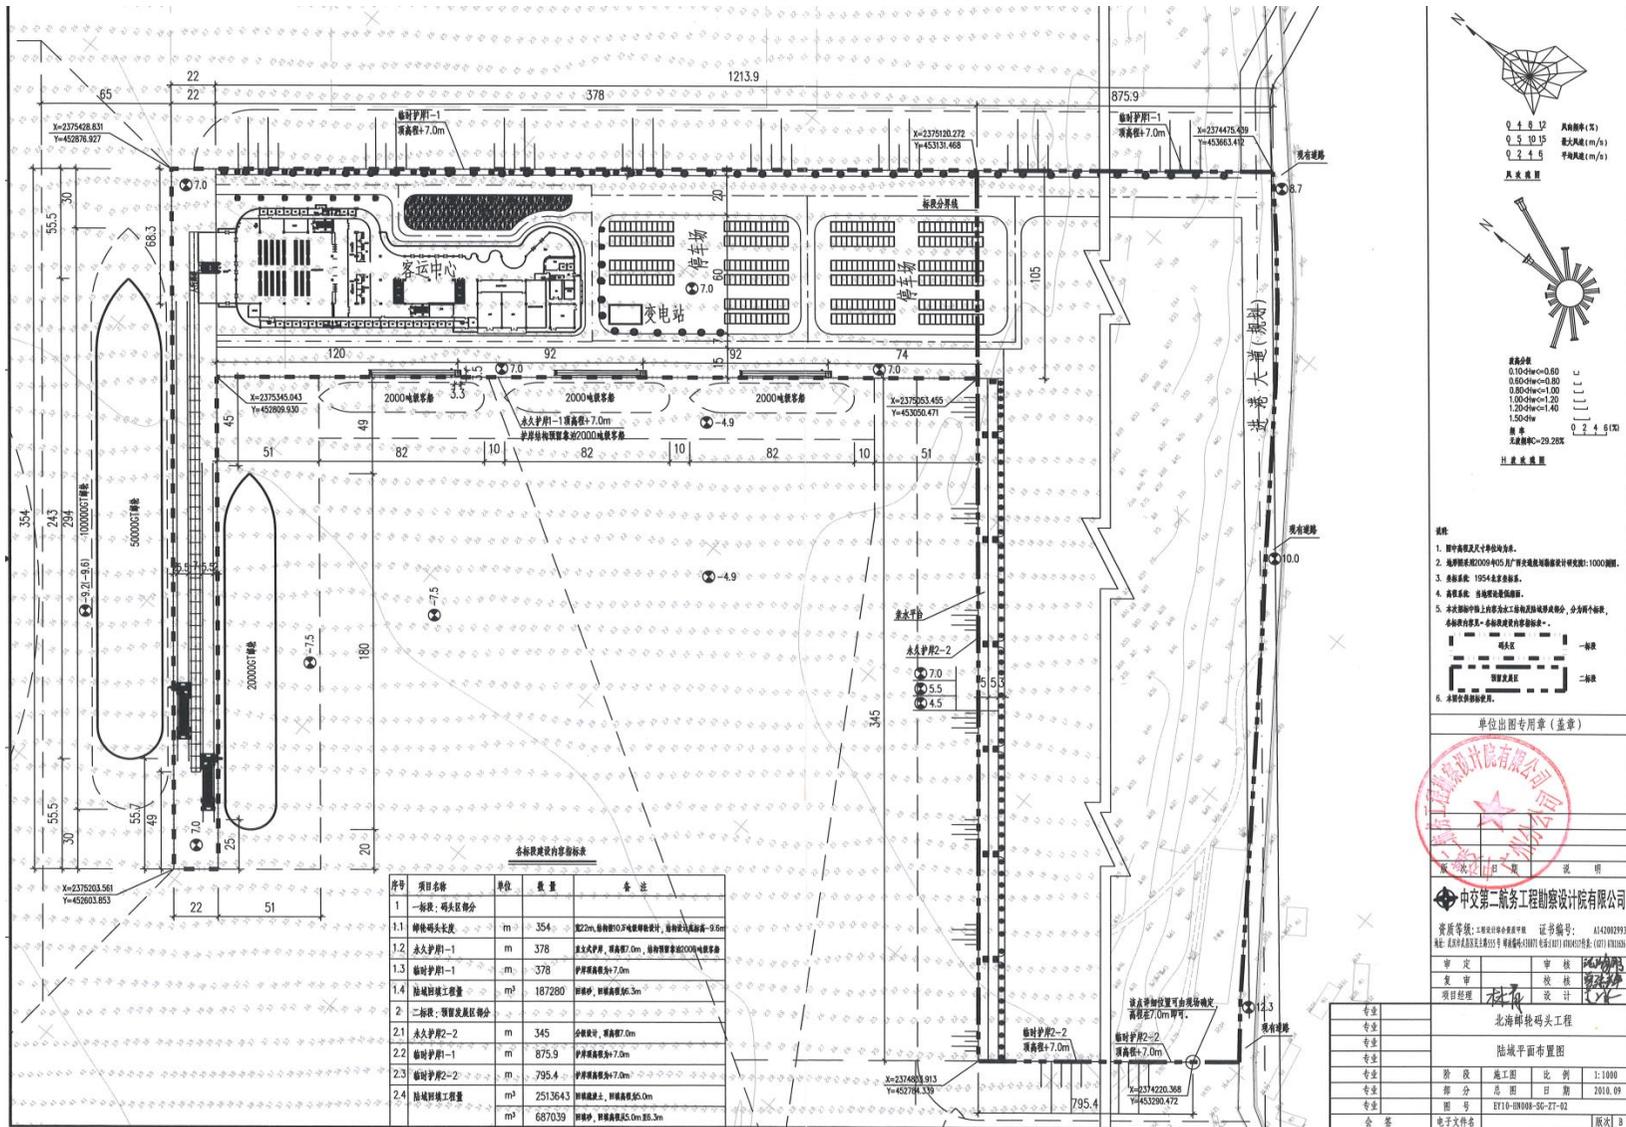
北海邮轮码头工程陆域平面布置设计图（截图自施工图设计，采用最低潮面）
